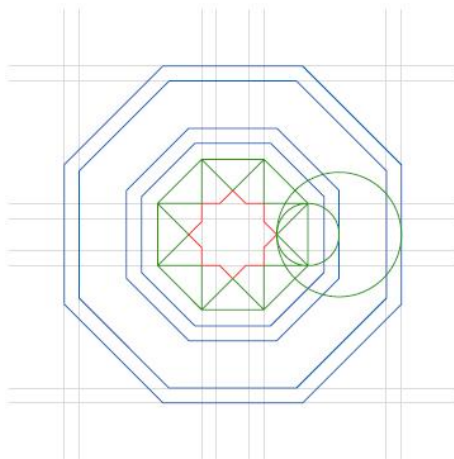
Construcción de los elementos estructurales que delimitan la rueda de este tramo.
